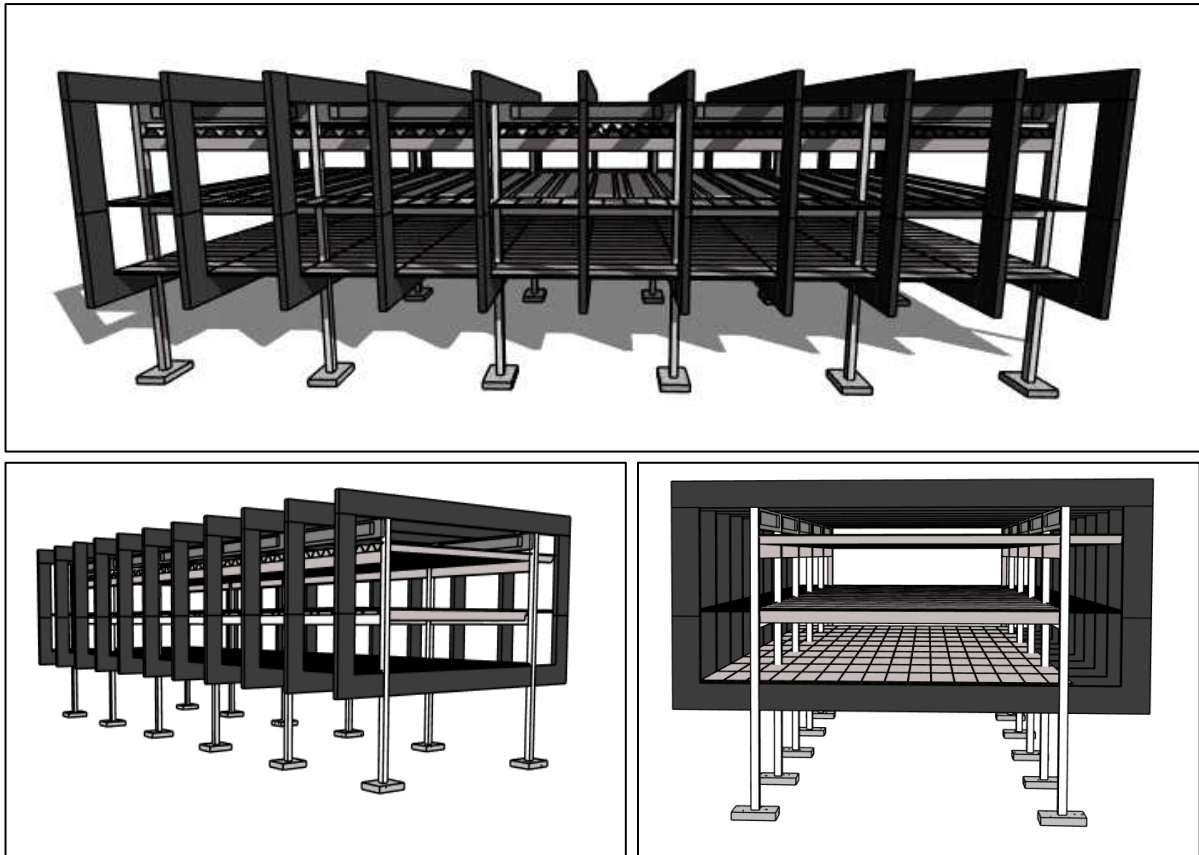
Esquema estructural de proyecto. Fuente: Autor.
